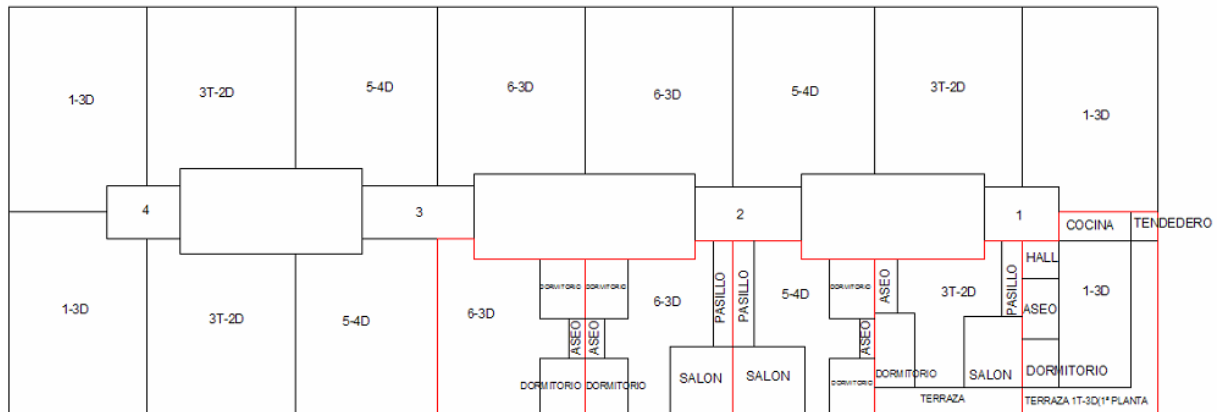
Esquema de ubicación de las tipologías de vivienda dentro de una planta de un inmueble.
